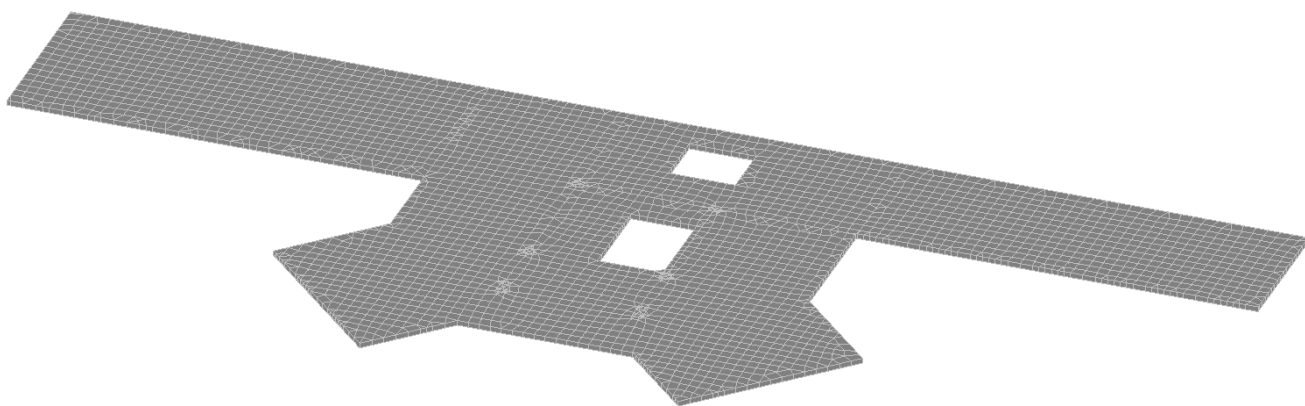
Расчётная схема плиты перекрытия в пространстве
